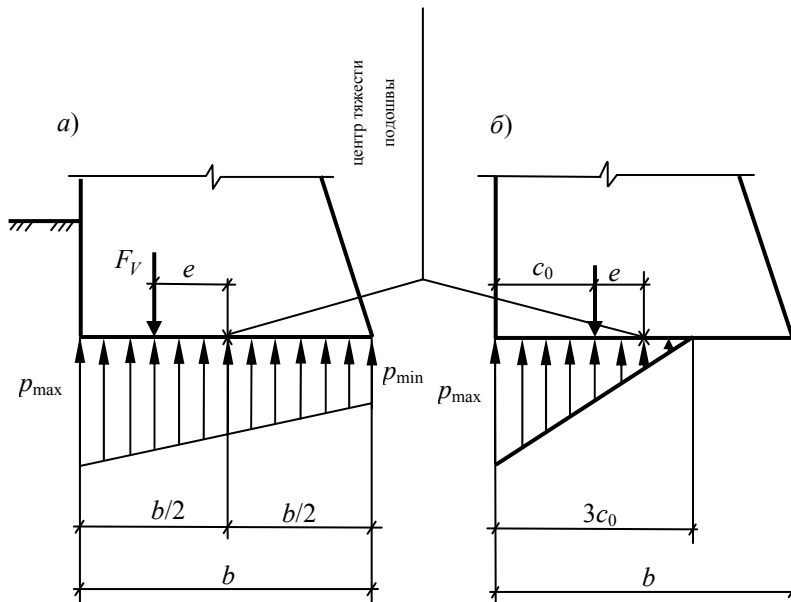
Схемы для определения давлений под подошвой фундаментной стены:
